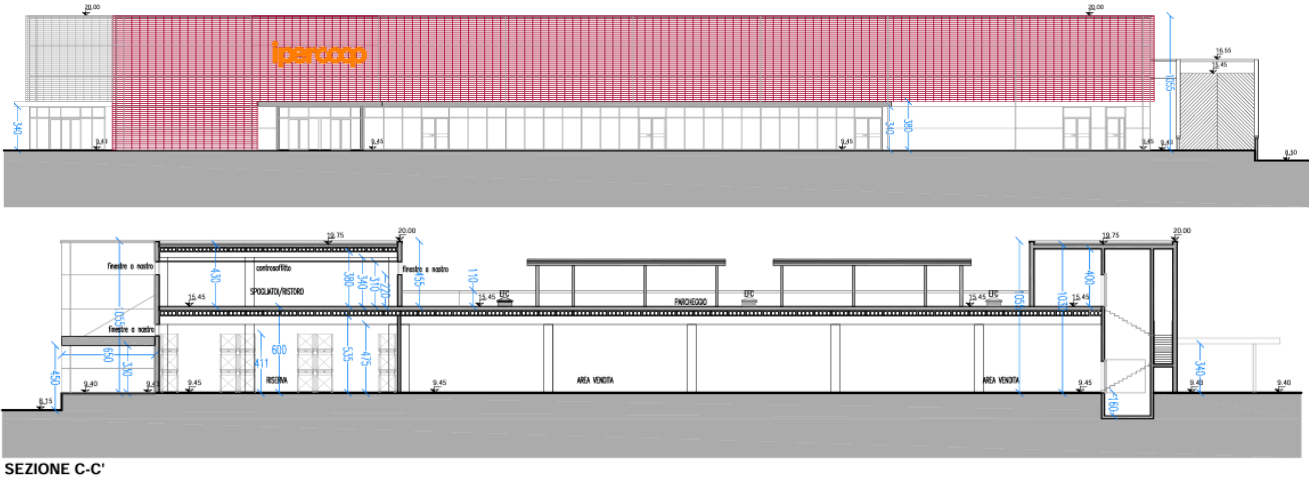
Prospetto (est) e sezione (est-ovest)
